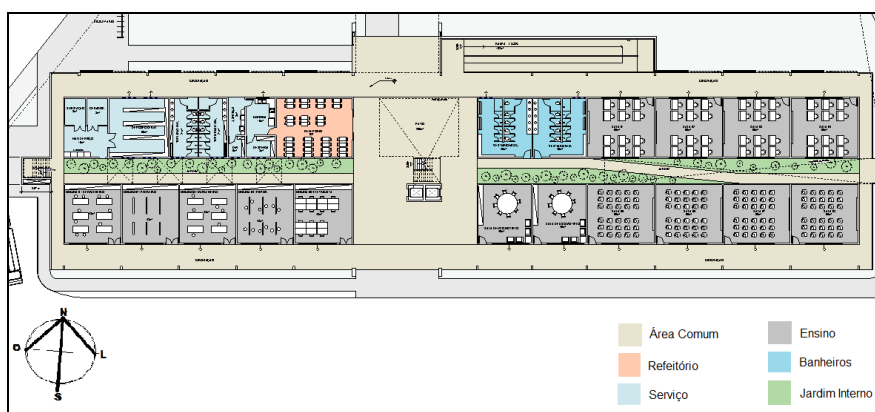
CETCON – Planta Baixa do Pavimento Térreo
